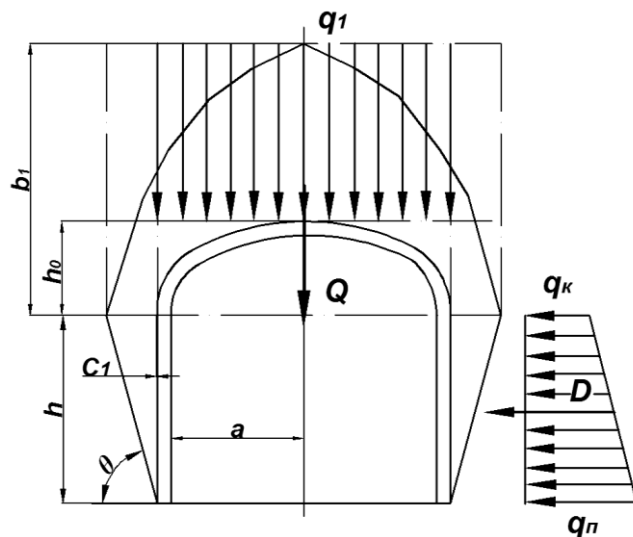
Схемы к расчету нагрузки на крепь при неустойчивой кровле и боках прямоугольно-сводчатой формы выработки
